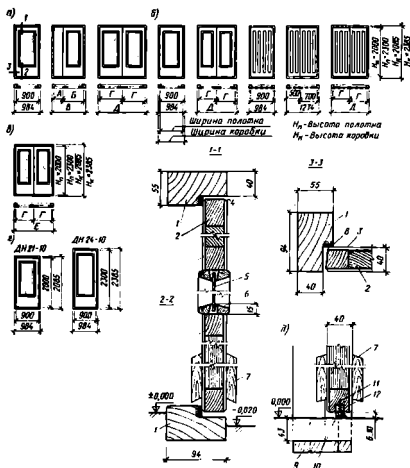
Двери деревянные наружные для жилых и общественных зданий:
